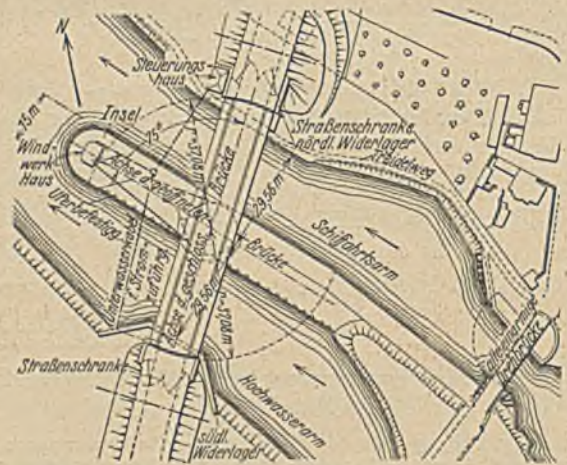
Die Drehbrücke über den Weaver-Fluß bei Acton Bridge. (Lageplan.)
